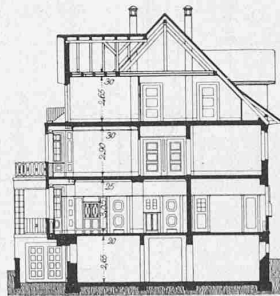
bis 6. Grundrisse und Schnitt des Hauses zum «Blumenegg». — Masstab 1 : 400.
